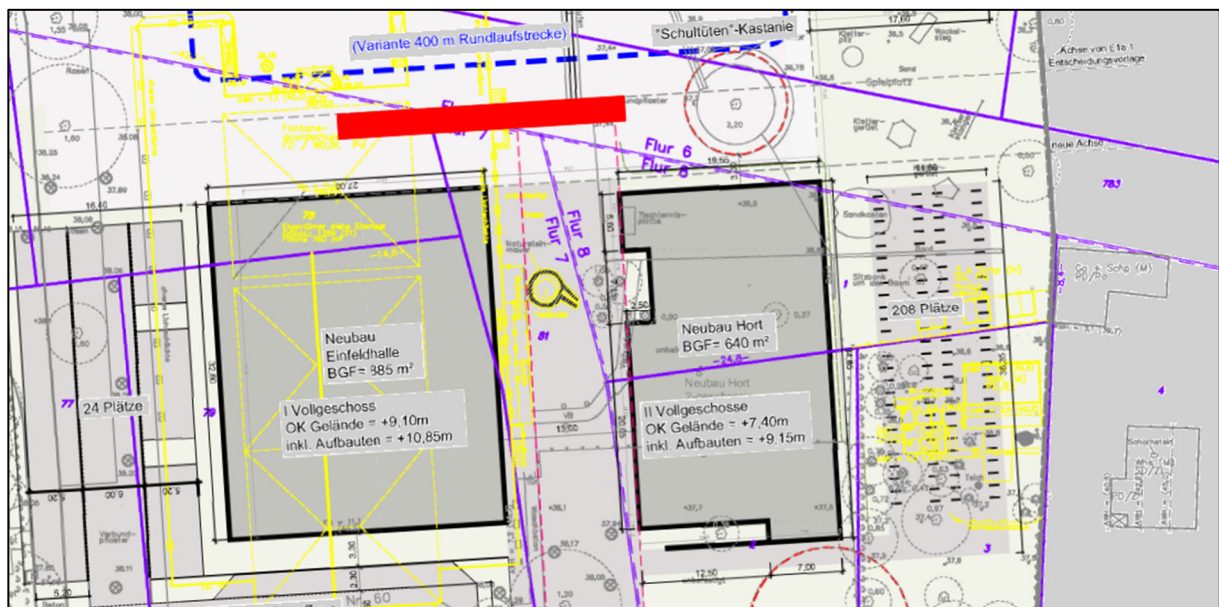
Lage Rigole Dachflächen – Neubau Einfeldsporthalle und Hort Außenanlagenplanung Variante 1
